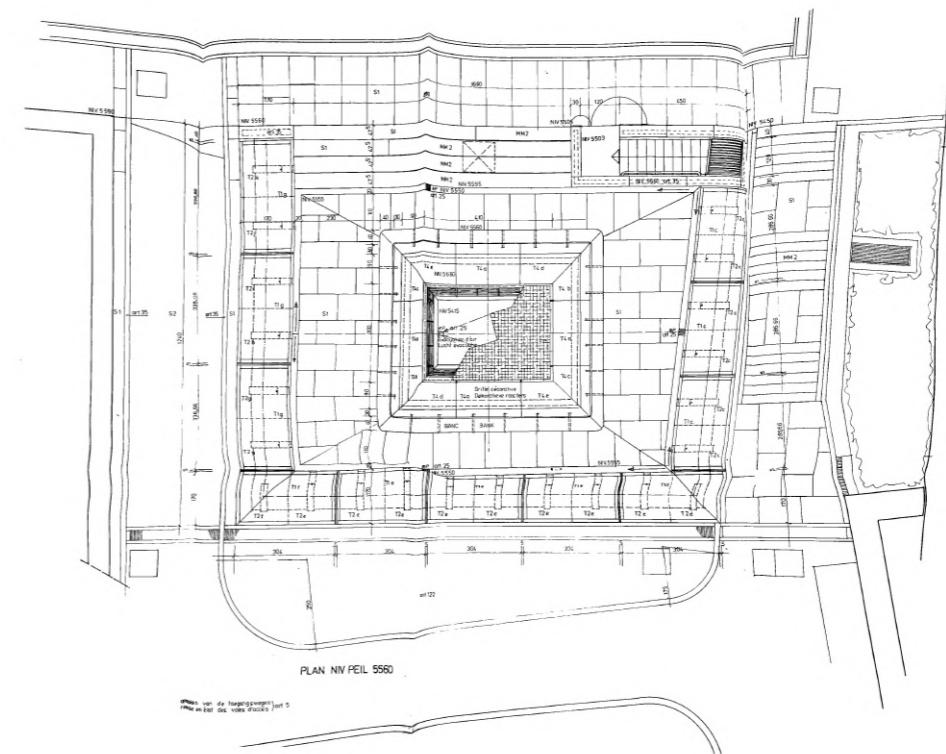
Plan du bloc technique tel qu'il apparaît sur les plans d'exécution de janvier 1978, avec la prise d'air située au centre, projet de la phase I.
